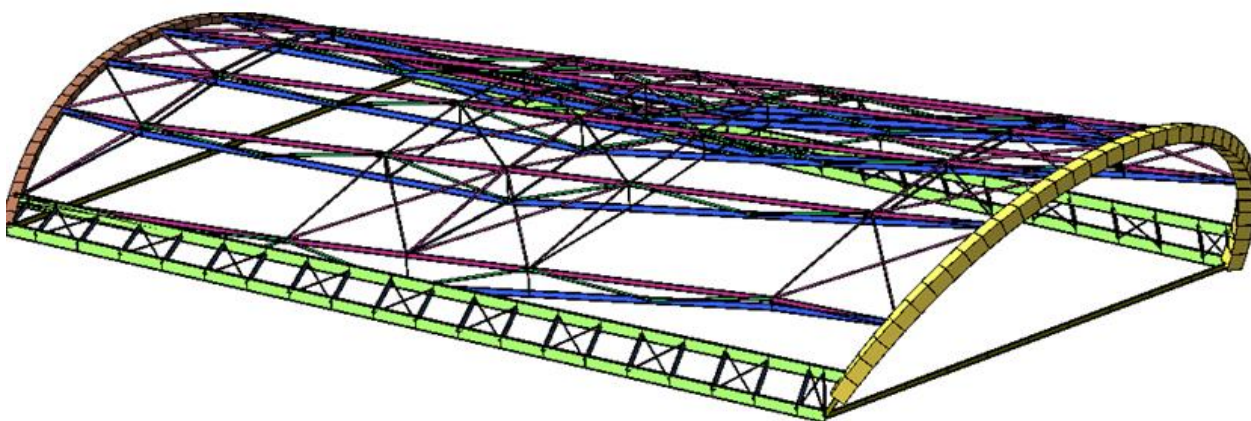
3-D схема будівлі з підібраними перерізами
